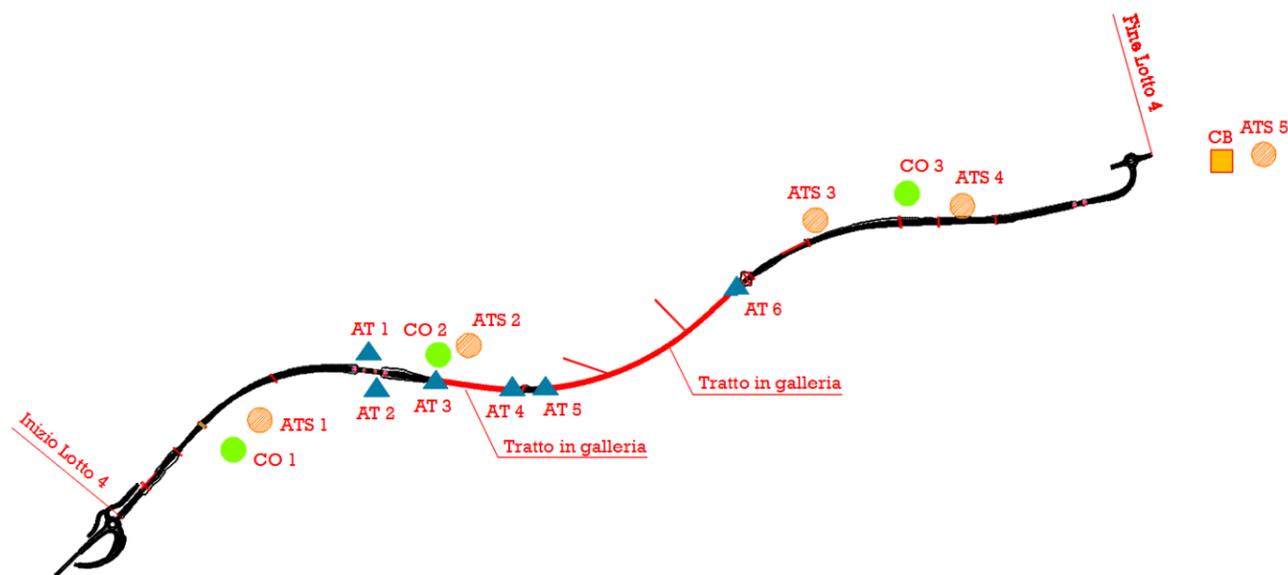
Localizzazione aree di cantiere lungo il tracciato
